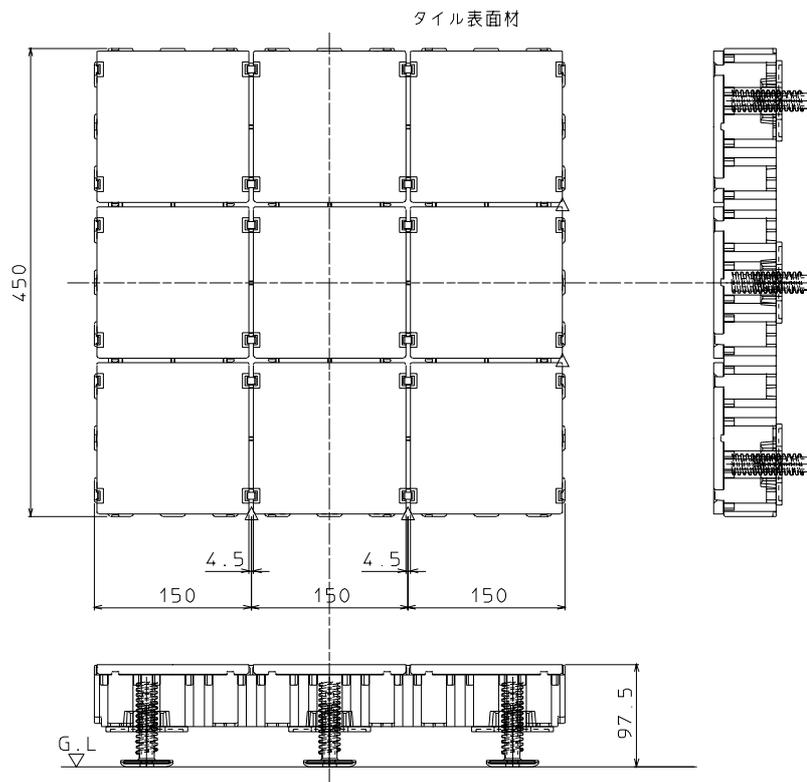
試験体図 (試験体 B : ユニバーサルデッキ木粉入り樹脂タイプ)
